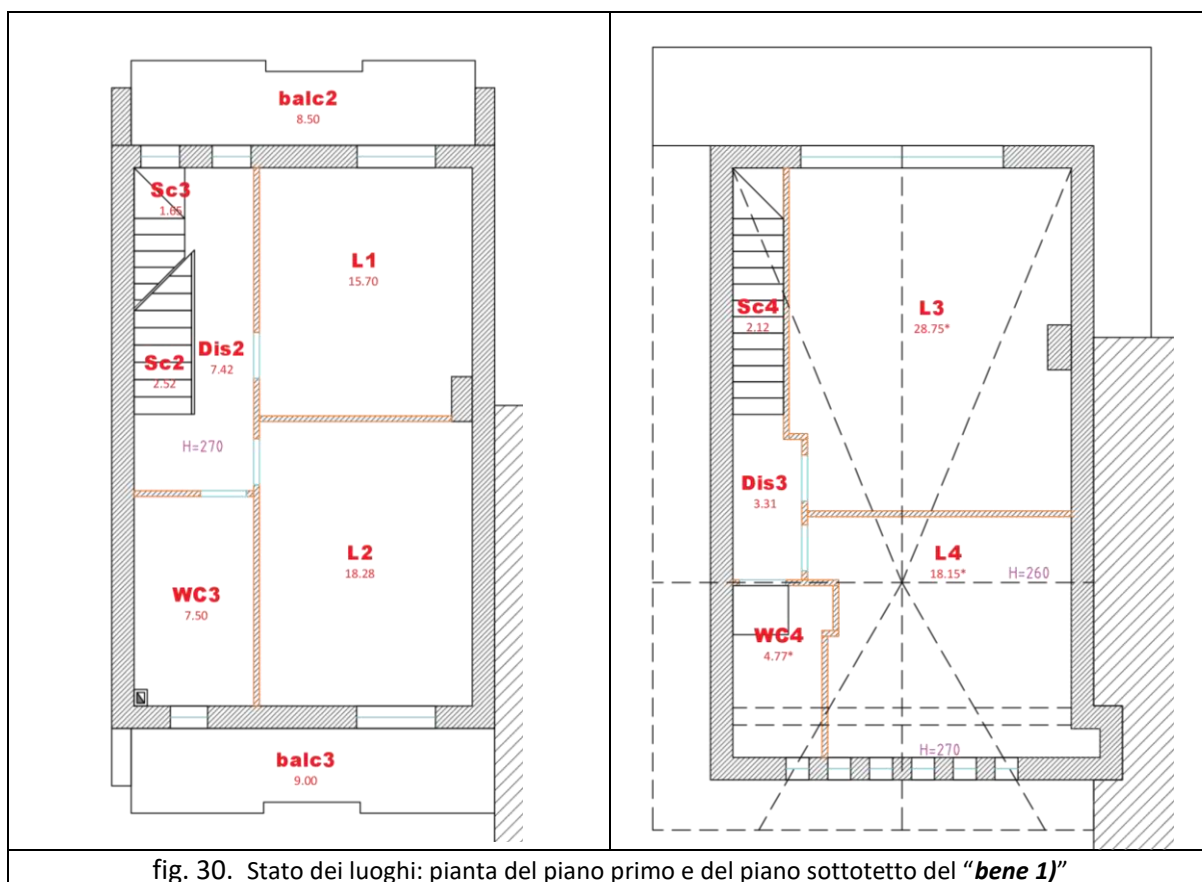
Stato dei luoghi: pianta del piano primo e del piano sottotetto del "bene 1"
